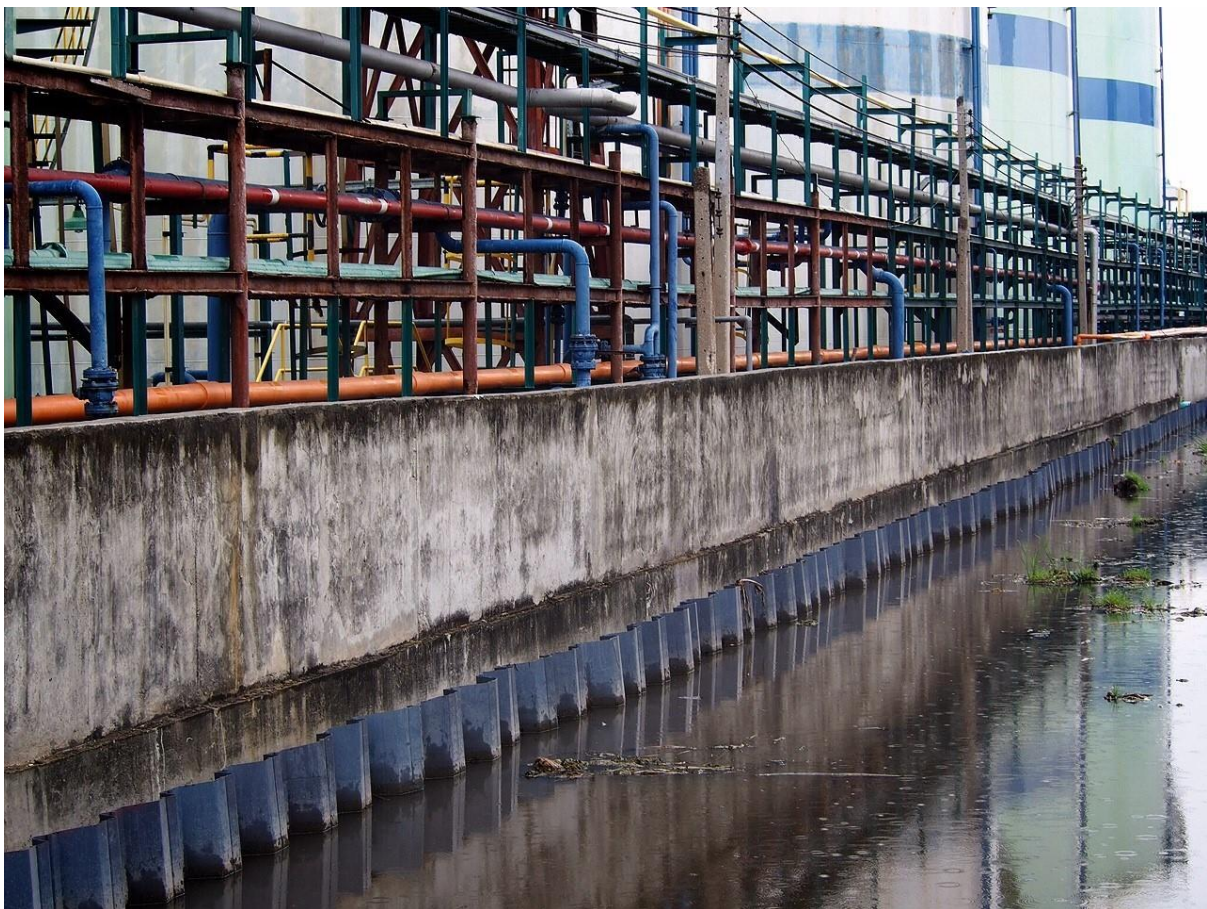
Tablestaca de PVC, usada para aislar del agua salada un muro de concreto armado (CETEAU, 2020).
